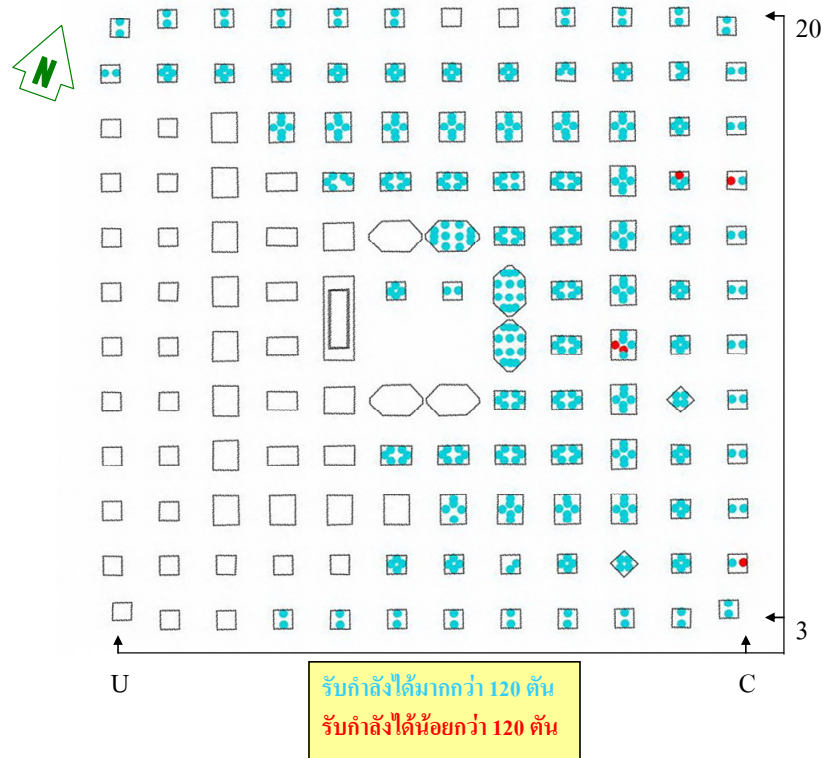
ผลการทดสอบ Static Pile Load Test เสาเข็มยาว 21 เมตร
